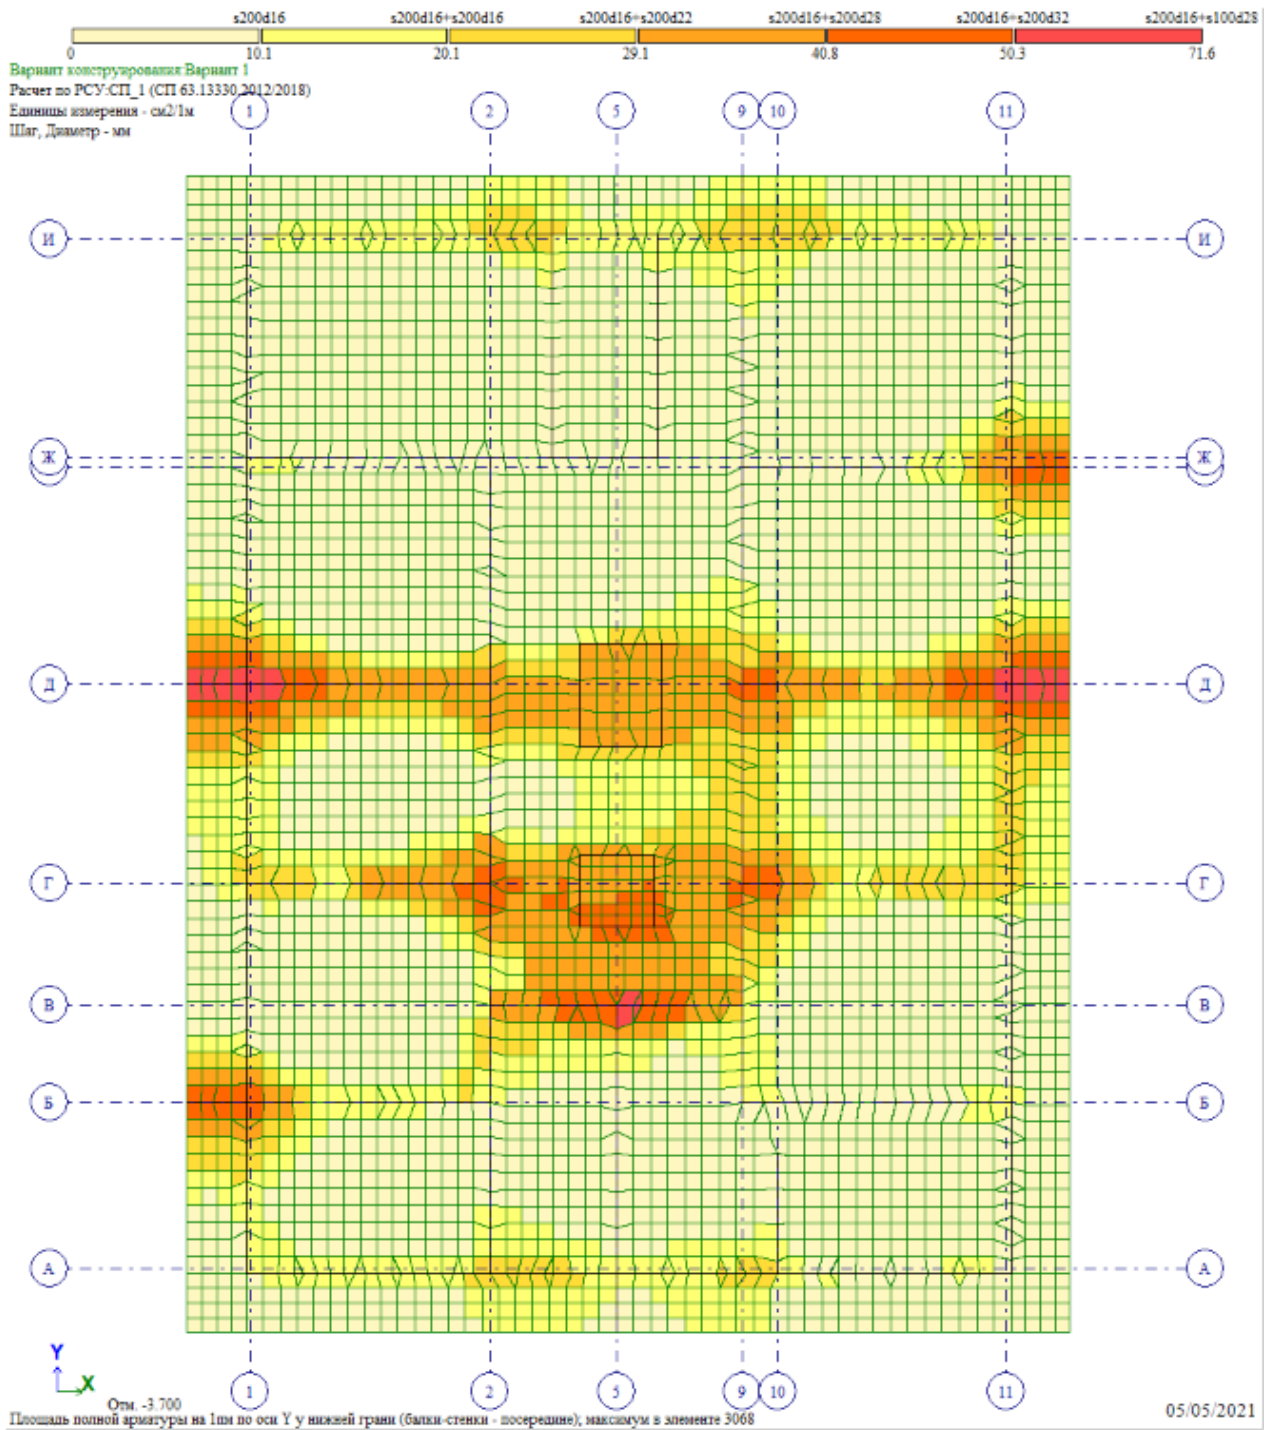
армирование нижней зоны фундаментной плиты по оси Y
